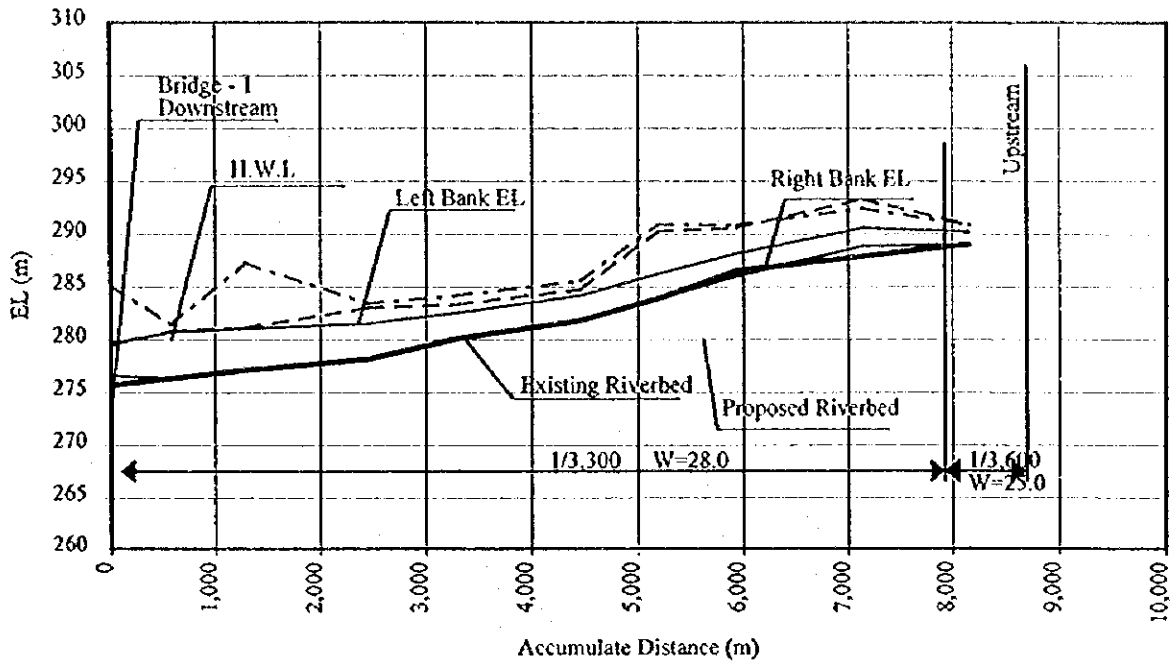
(3) PERFIL LONGITUDINAL DEL MEJORAMIENTO DE DRENAJE
